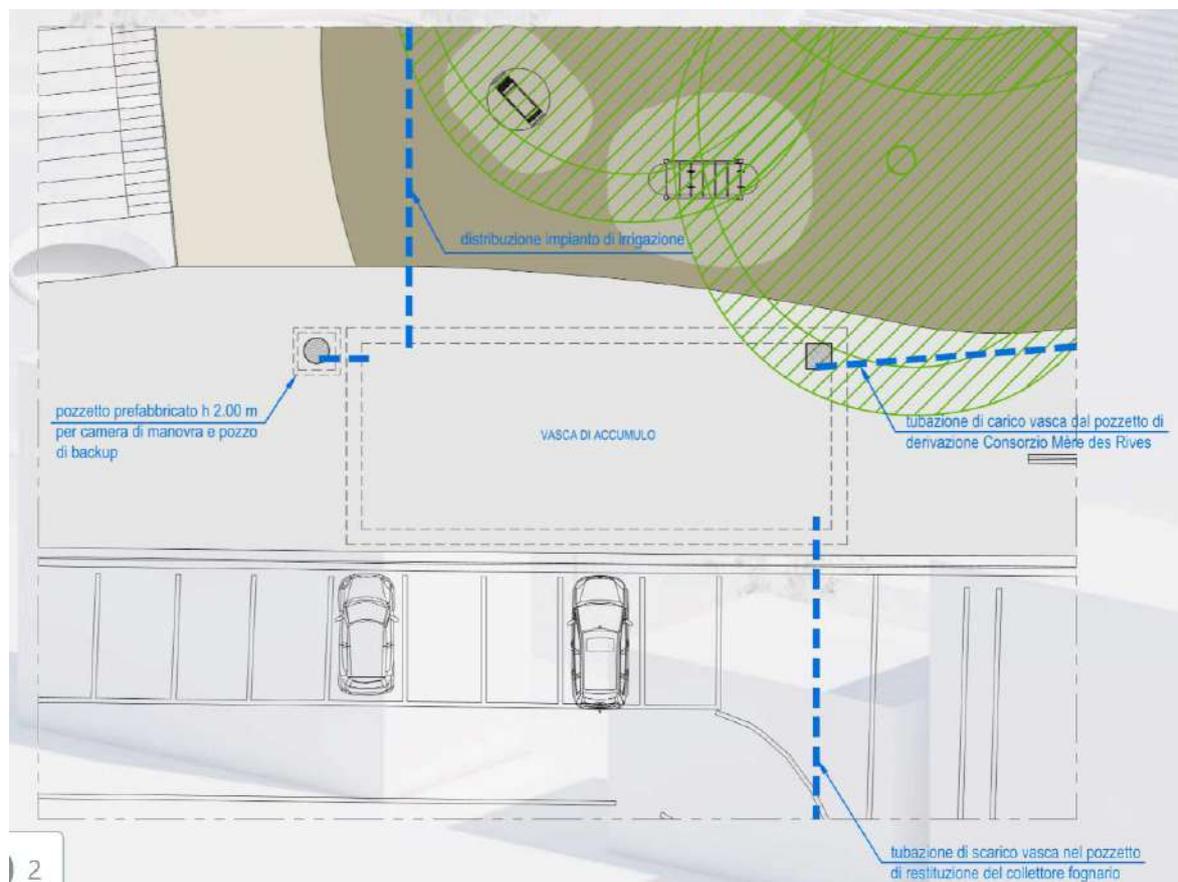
Planimetria di progetto Vasca – Arch. Roberto Rosset
